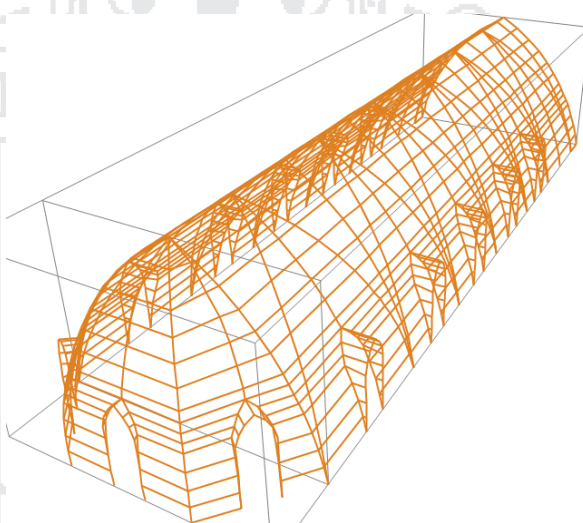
Geometría del modelo elementos tipo Frame de cobertura.
